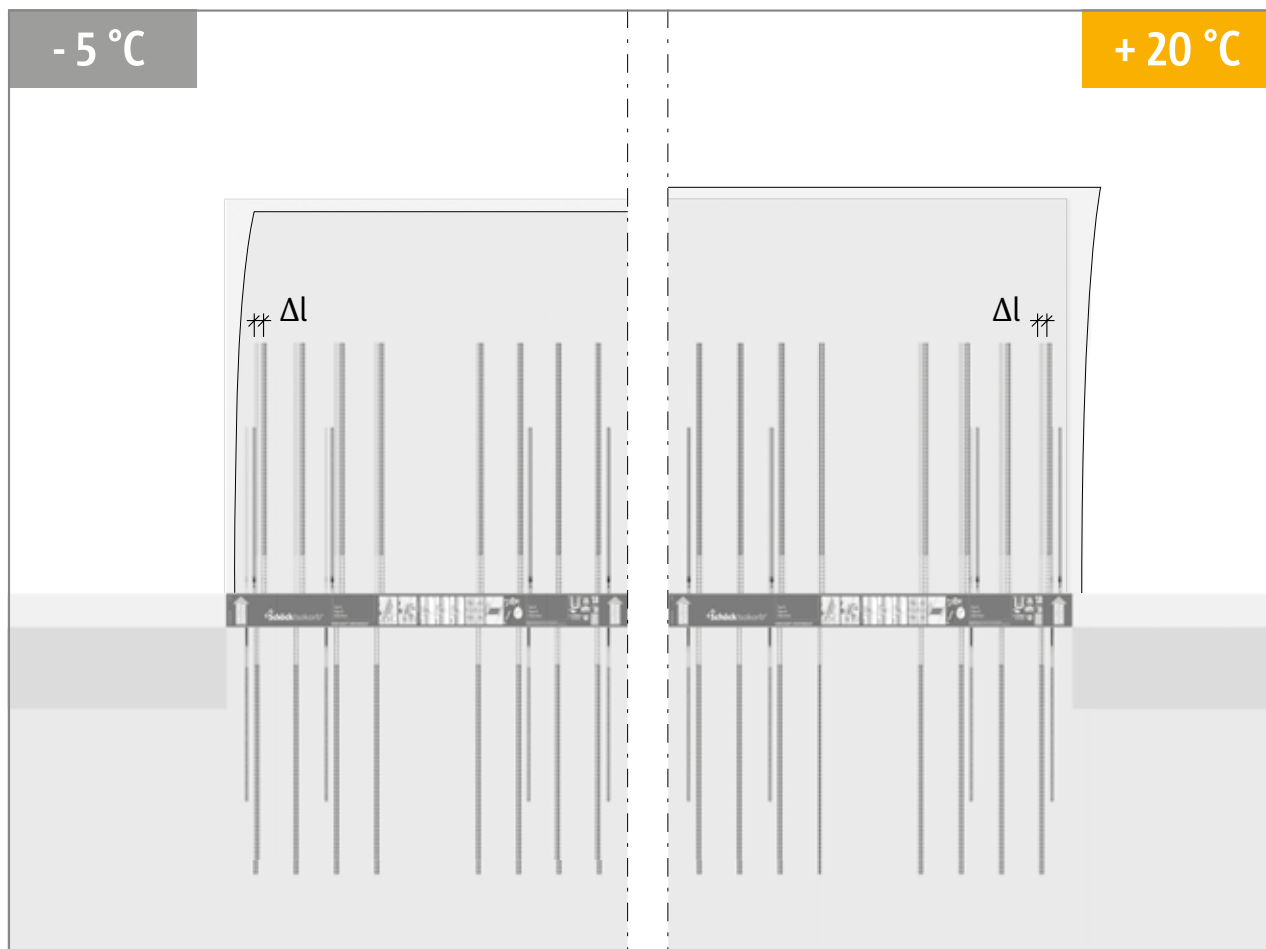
Krčenje balkonske plošče zaradi ohlajanja, obremenitev Schöck Isokorb®
